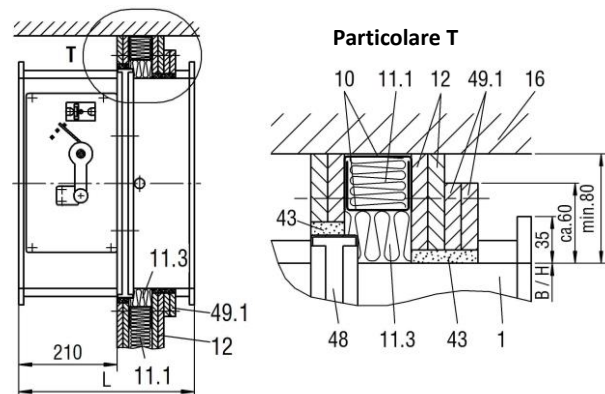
montaggio a secco in pareti divisorie leggere sotto soffitti massicci
